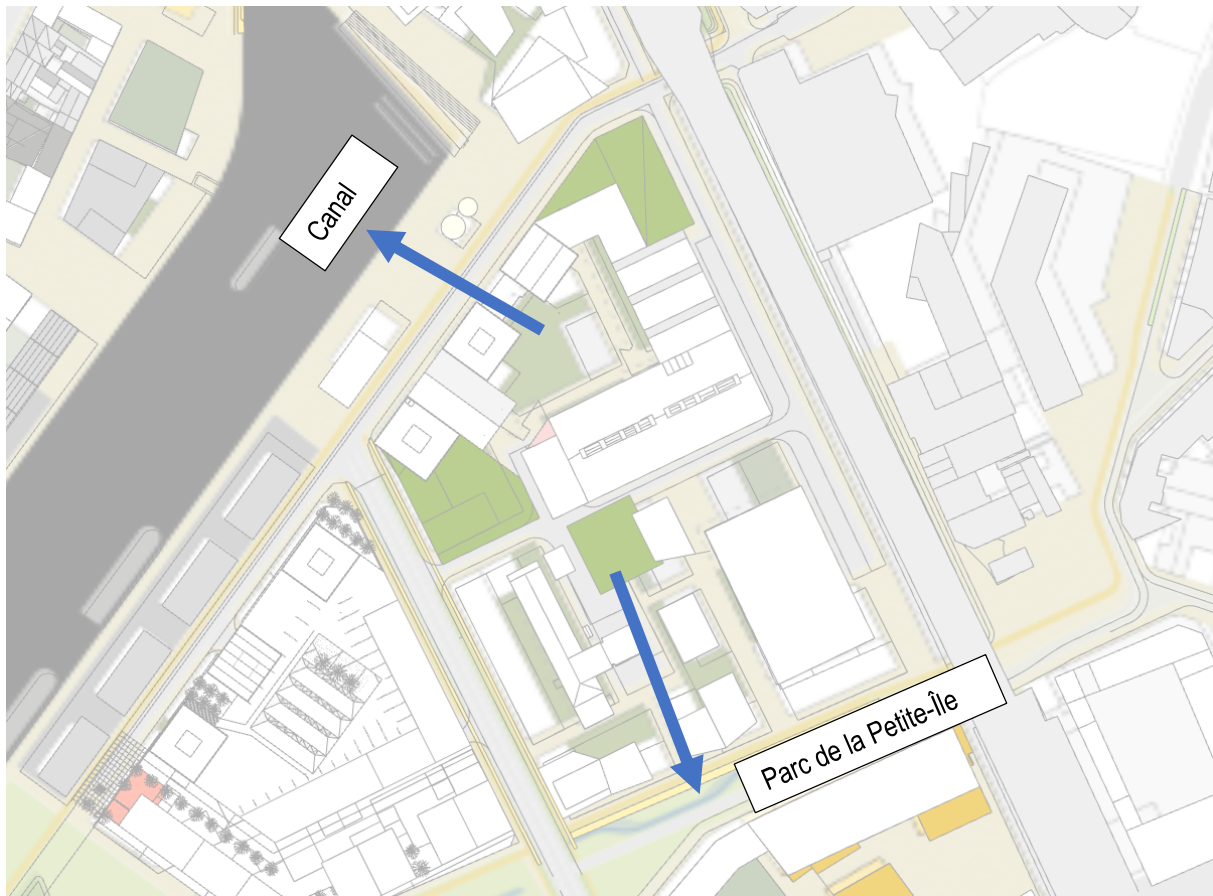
Rejet possible des trop plein pour le système de gestion des eaux par infiltration (ARIES, 2024)
